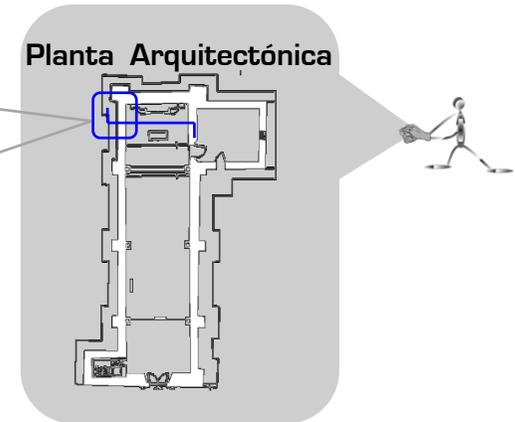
Planta Arquitectónica Parroquia de Santa María Nativitas
